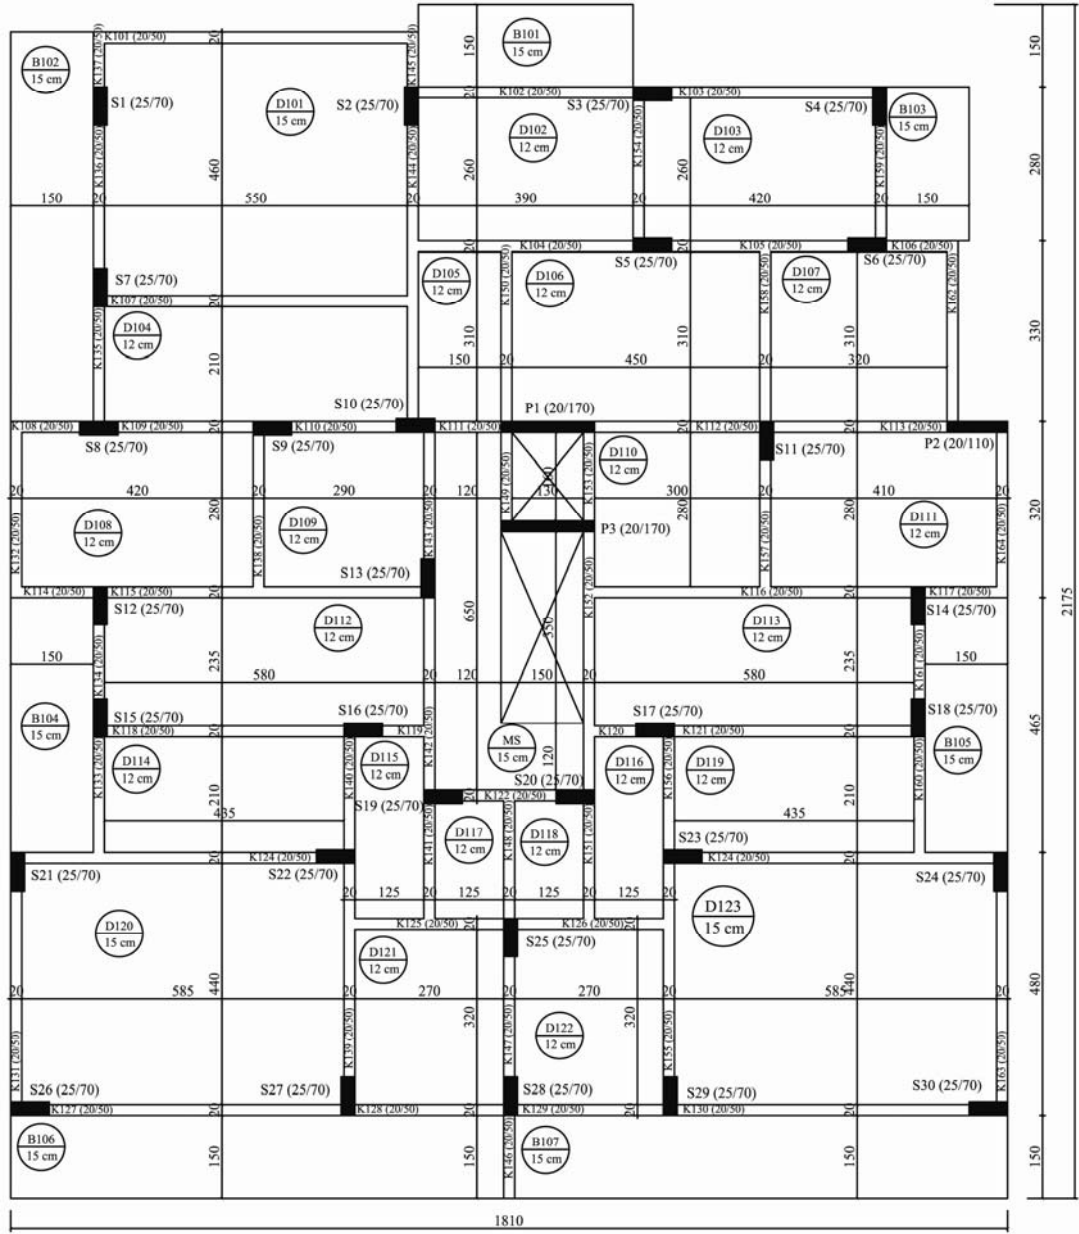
B7\_1'in kat kalıp planı
